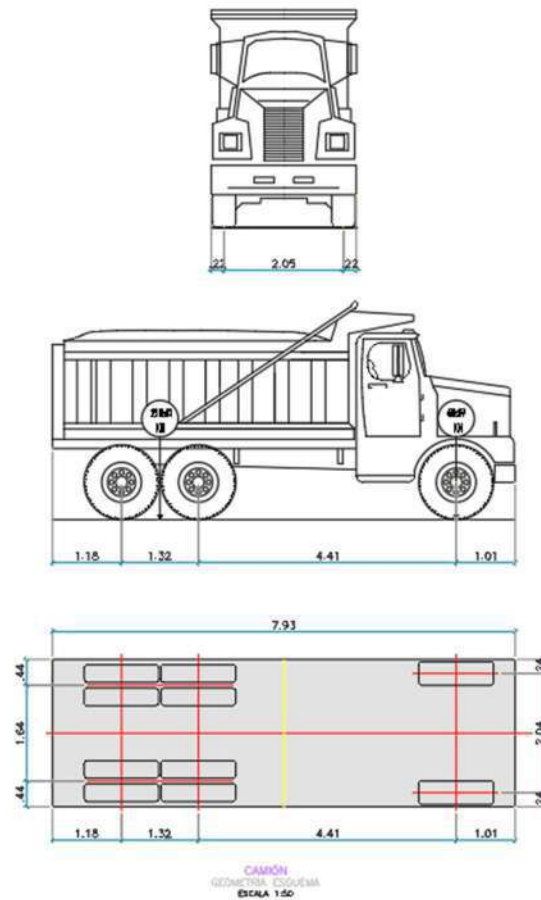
Geometría y cargas de camión para la prueba (Eje trasero 220kN – Eje delantero 60kN).
